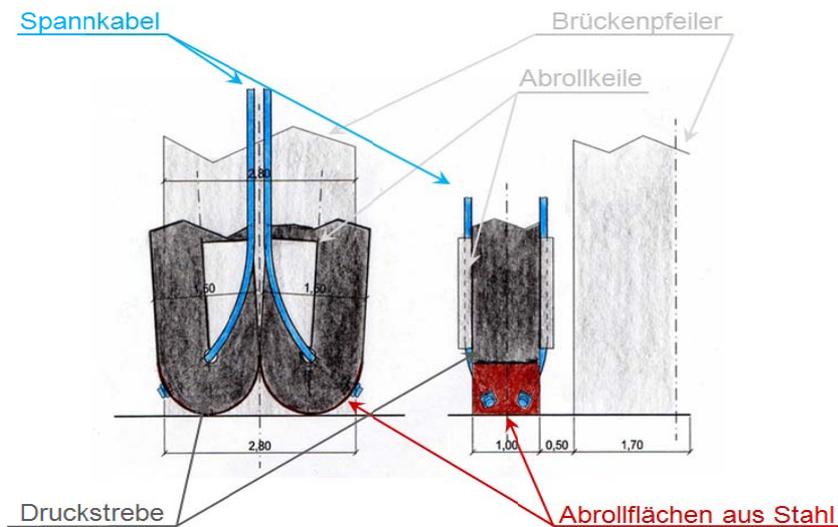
Unteres Druckstrebenende vor dem Hebevorgang - D.o.H.
